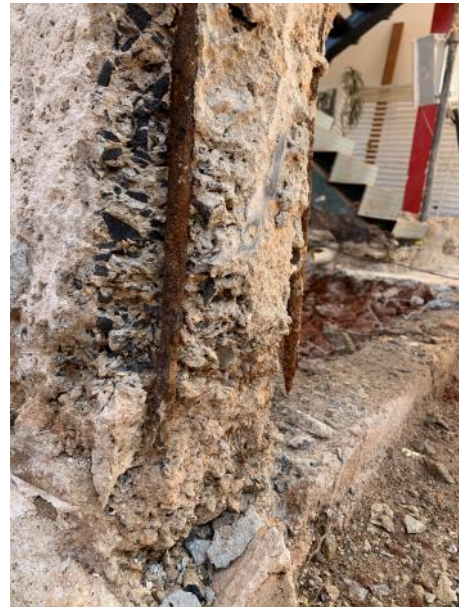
Armadura da base do pilar exposta, corroída e sem conexão com vigas ou fundação.
